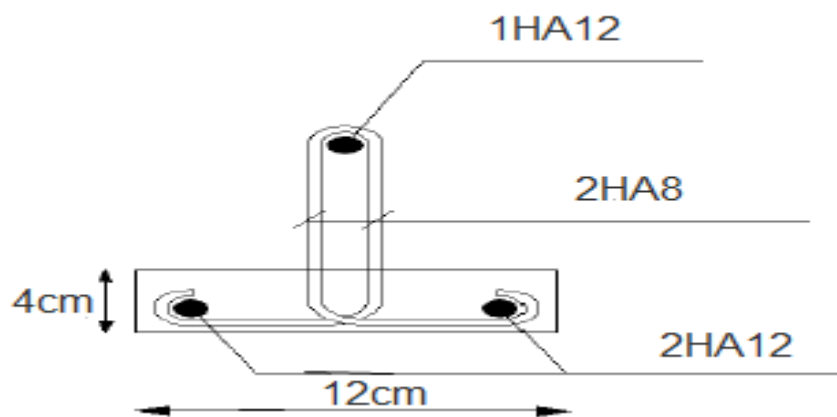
Schéma de ferrailage des poutrelles en appuis et en travée
